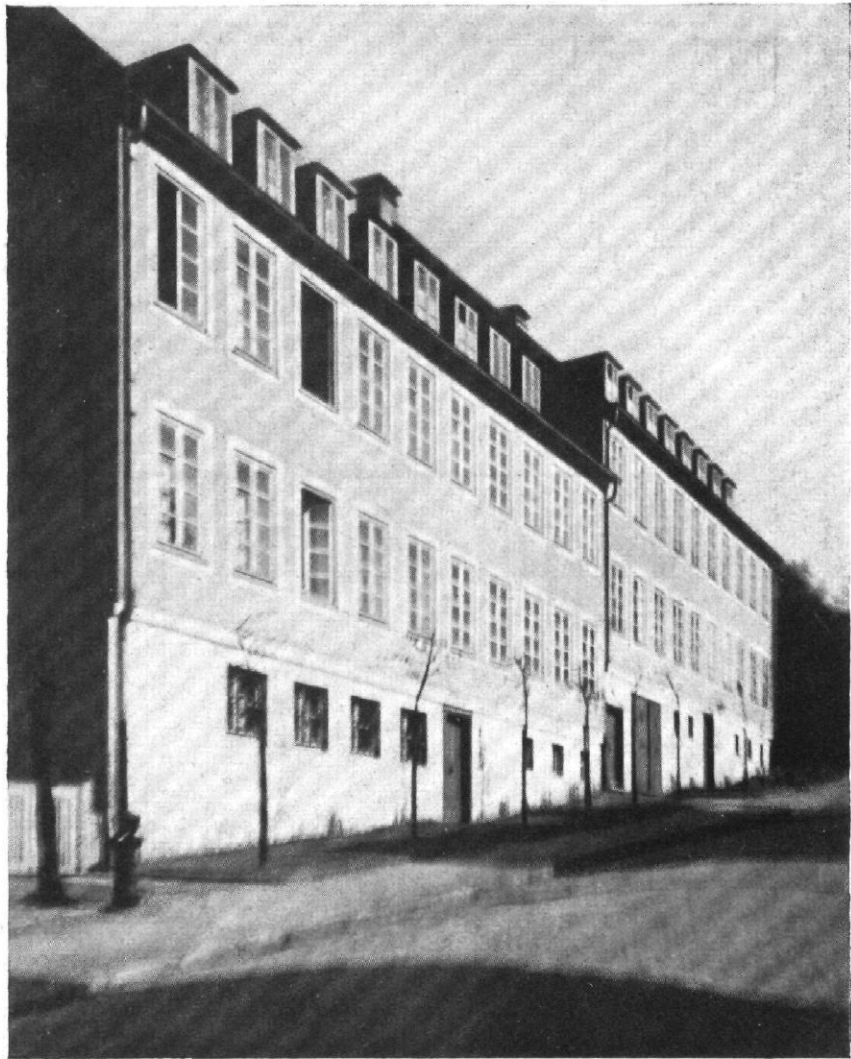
| Wohnbausbauten an der Molinussstraße, Barmen
